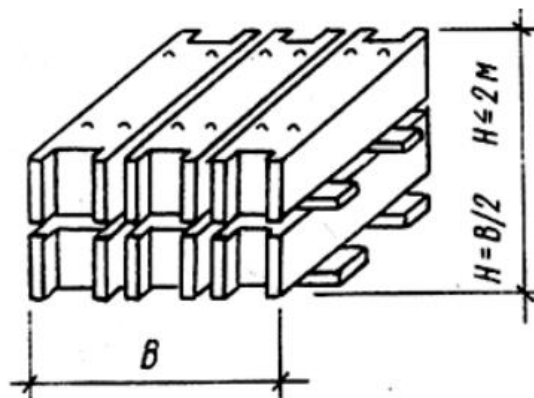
Схемы складирования стеновых фундаментных блоков
